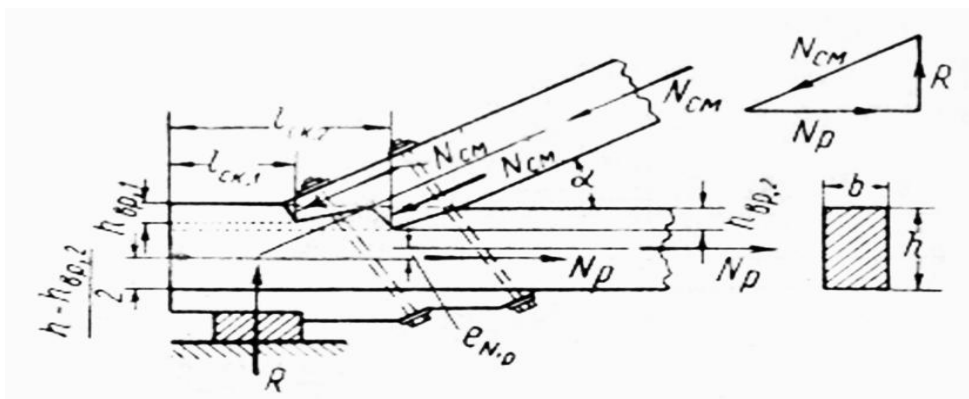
Конструкція лобової врубки з подвійним зубом
